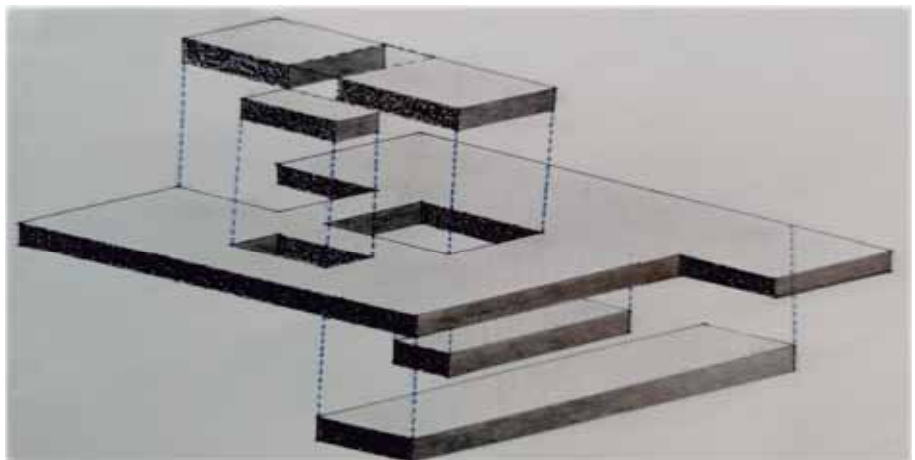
Extracción de la volumetría que dió como resultado las plantas arquitectónicas.
